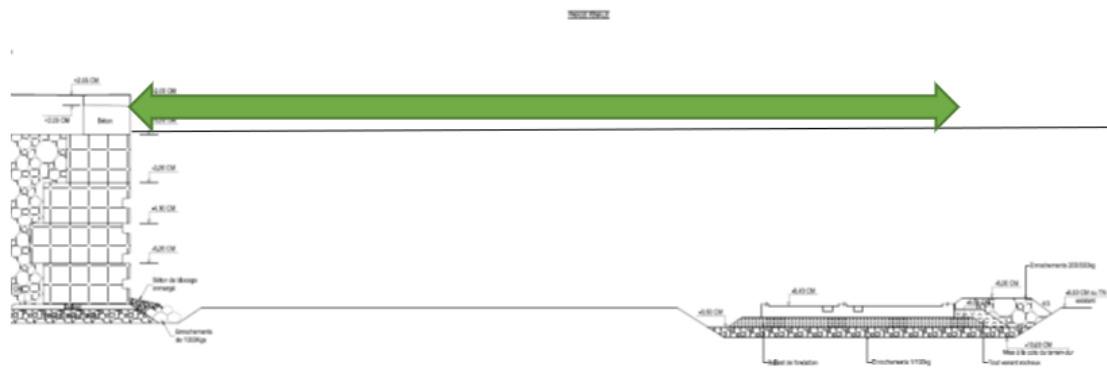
Etat final – Coupe – Après achèvement des travaux – Etendue de la zone rendue à la mer (43 m de large)
